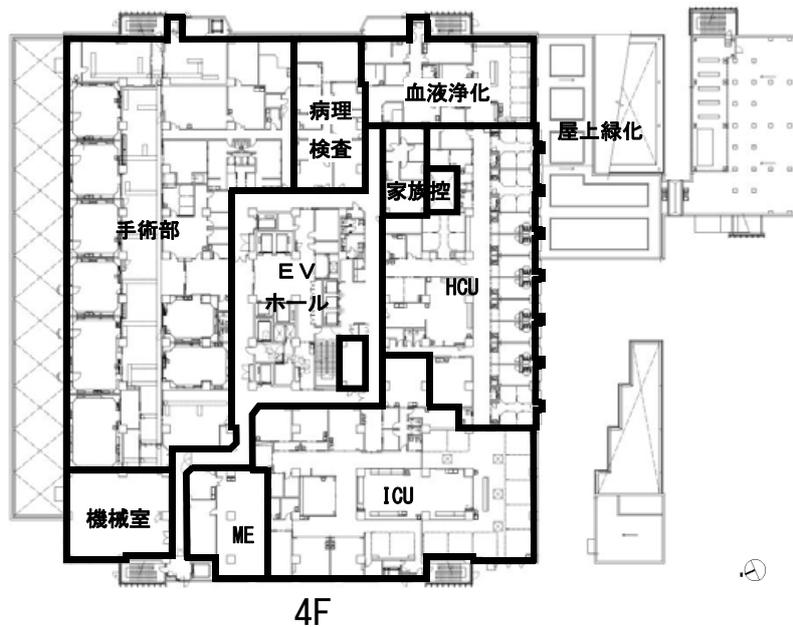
(1) 病院本館建築平面図 (4階) (完成時)
